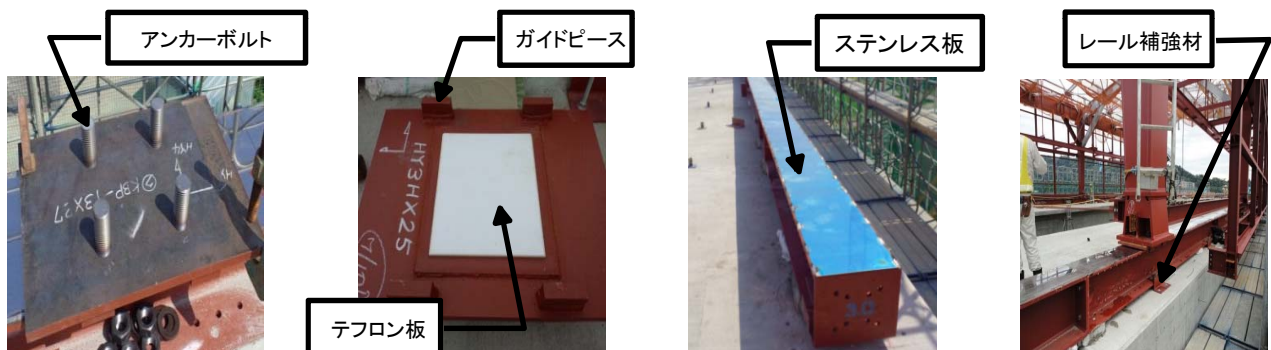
仮アンカーボルト付ベース 写真-2 テフロン板ベース 写真-3 ステンレス板付H型鋼 写真-4 レール補強
